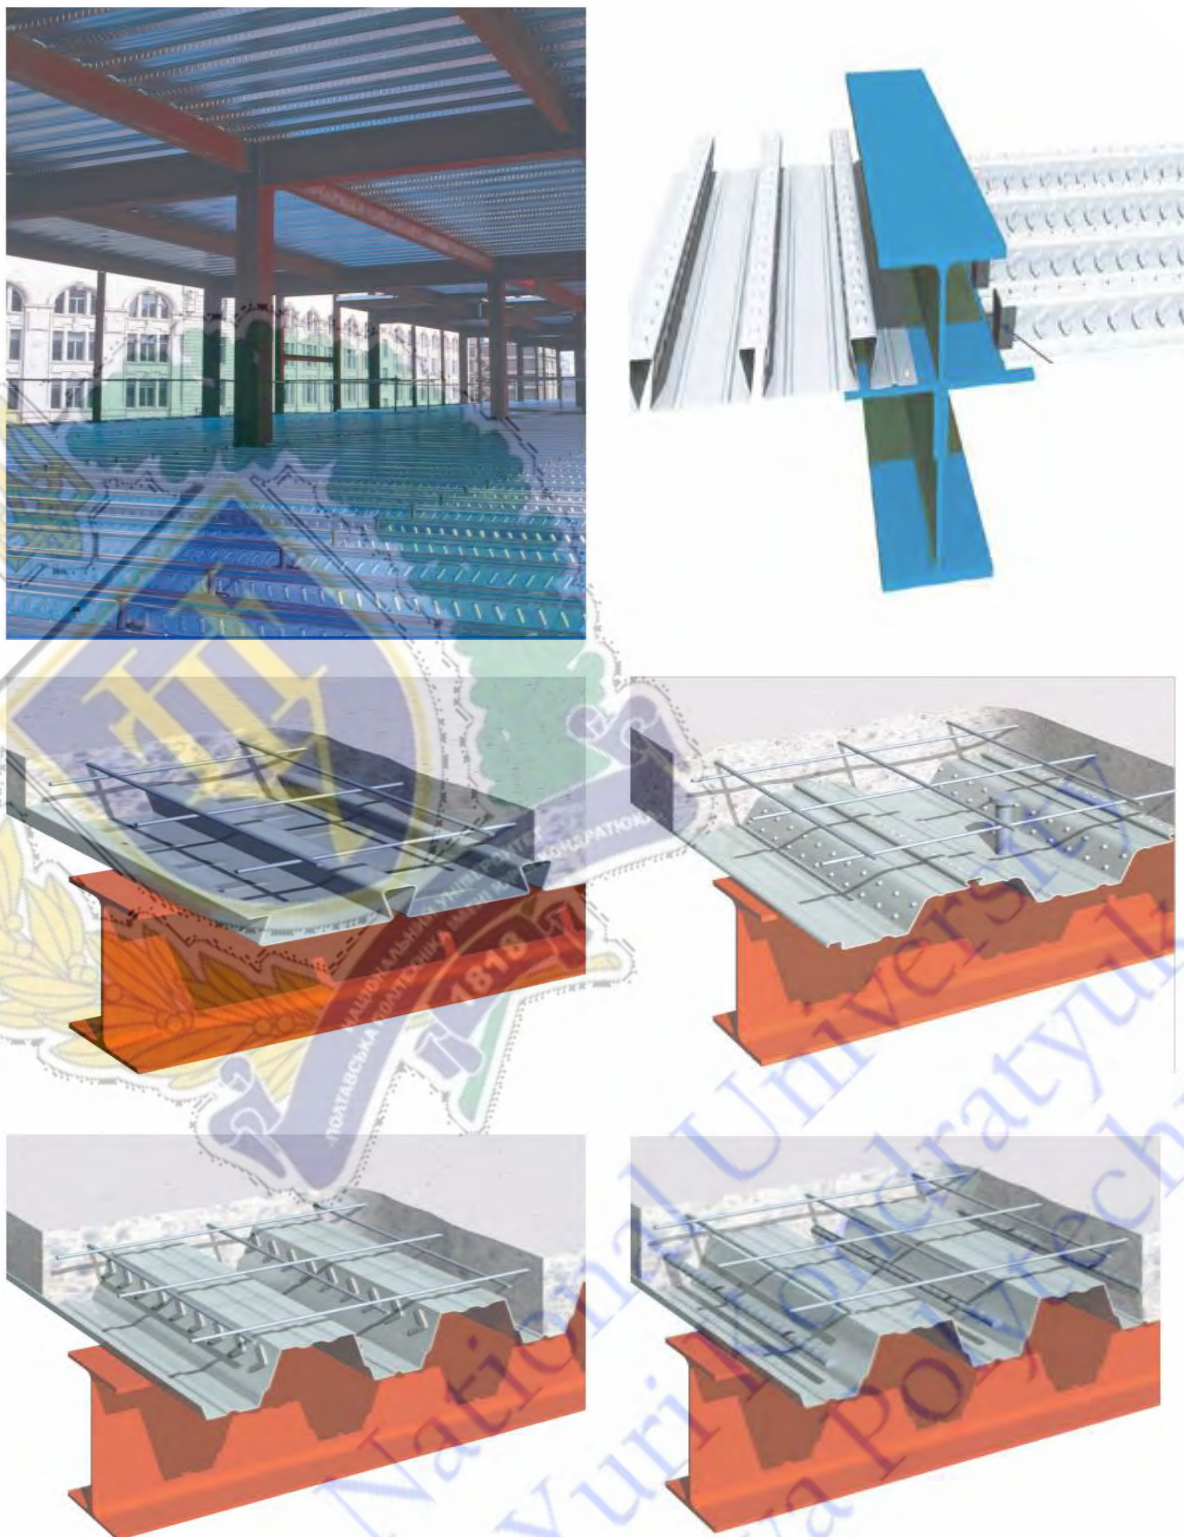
Конструктивне рішення комбінованих сталезалізобетонних балок перекриття із залізобетонною монолітною верхньою полиці, яка улаштовується за допомогою нез'ємної опалубки із сталюого профільованого листа.
